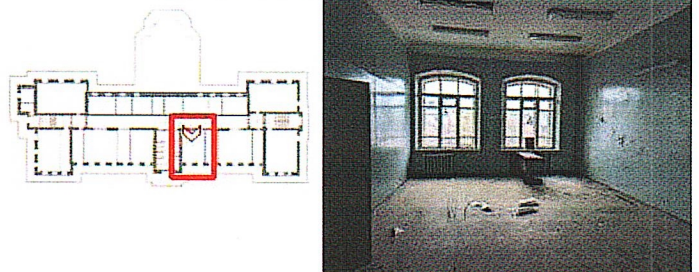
Междуэтажные плоские перекрытия, кирпичные перемычки оконных проемов
